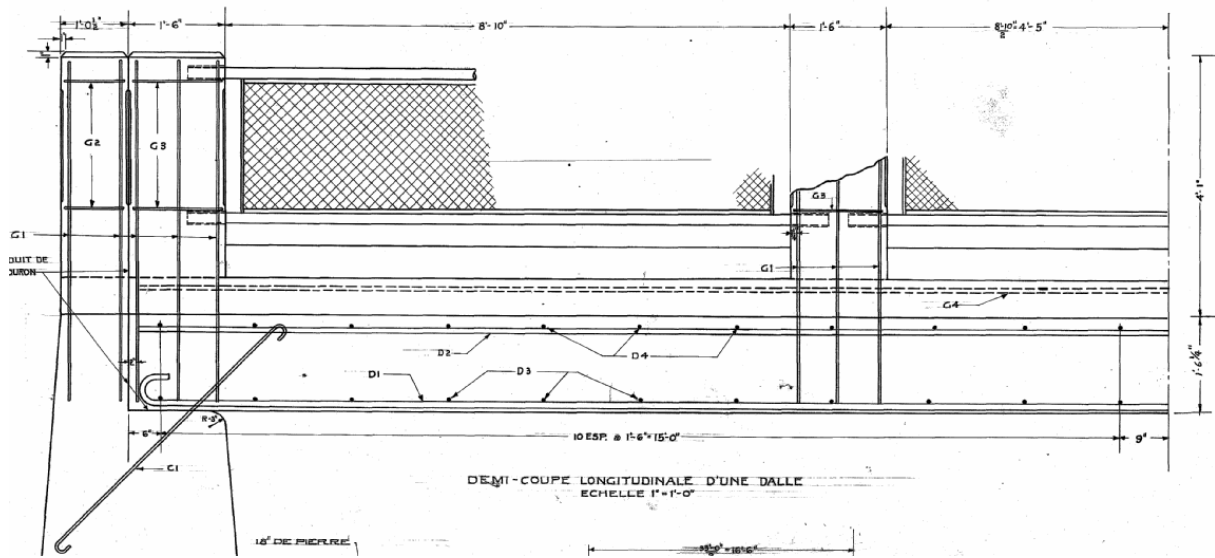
Demi-coupe longitudinale (plans d'origine [5])
